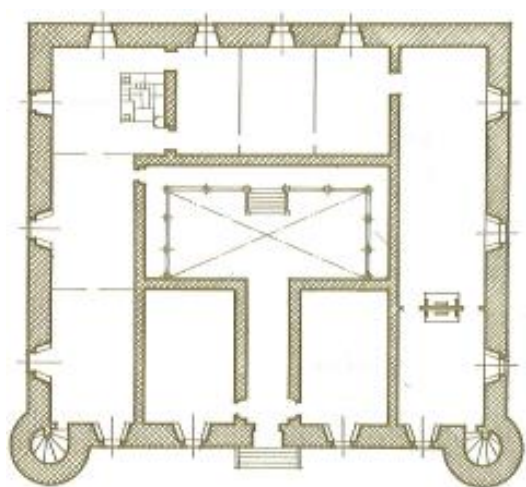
Pazo de Borraxeiros. Plano de distribución de planta baja con corredor en patio central. Ídem, p. 445.
